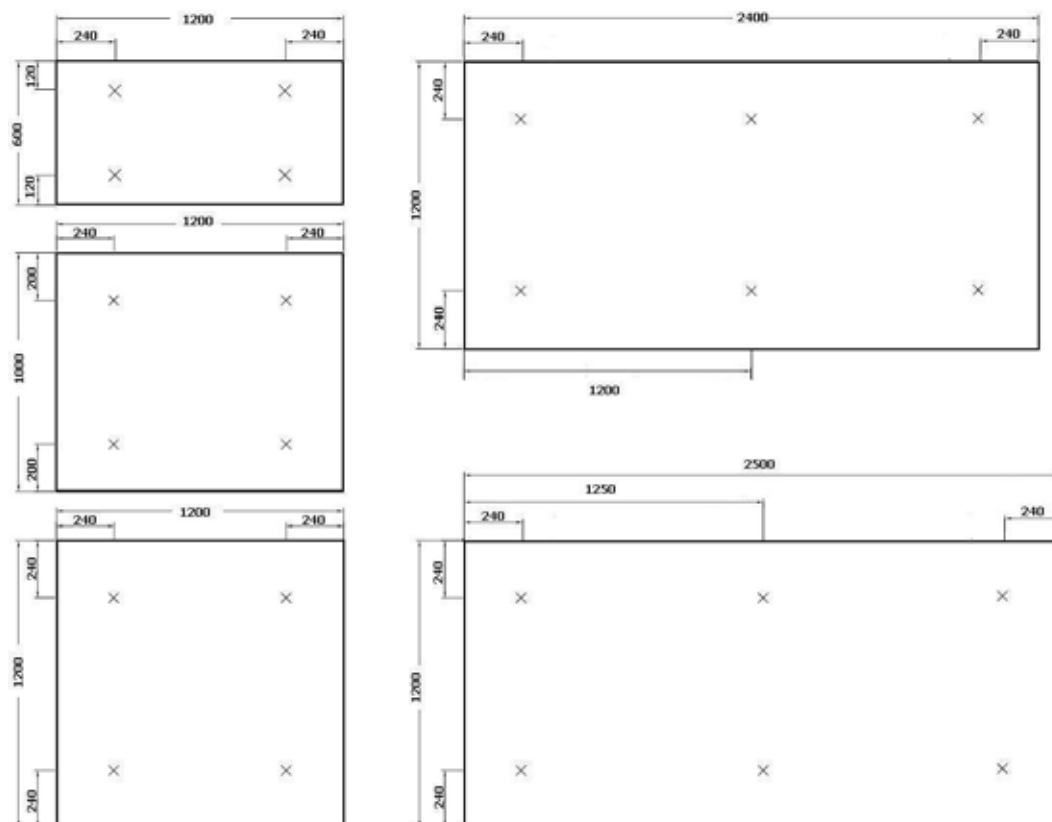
Plaatsingspatroon voor de mechanische bevestigingen
